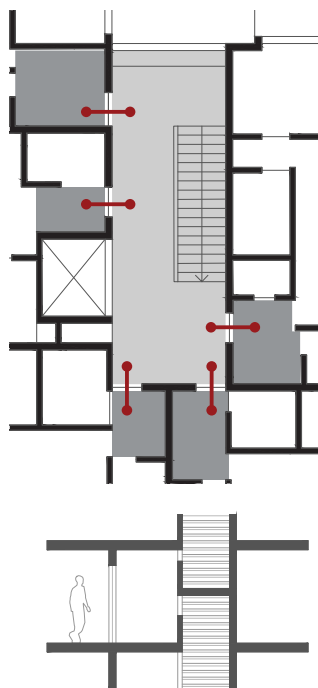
Acesso aos fogos, Hansaviertel. Planta e corte Escala 1:200.
